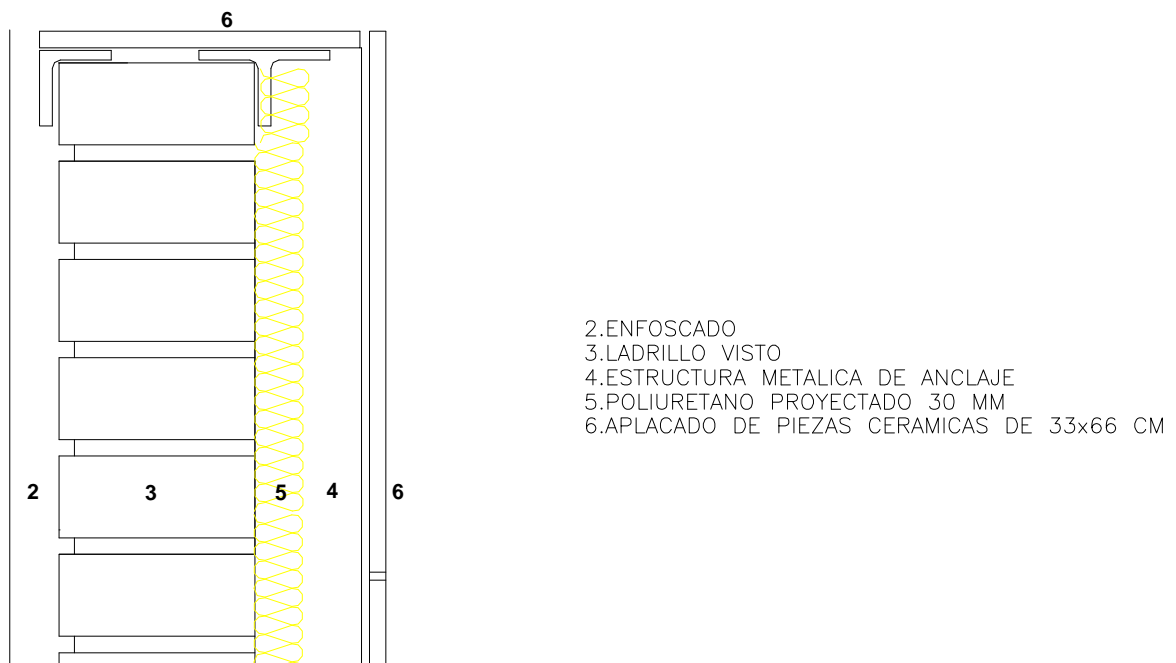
Detalle constructivo de la junta superior de la fachada ventilada de juntas abiertas objeto de estudio
